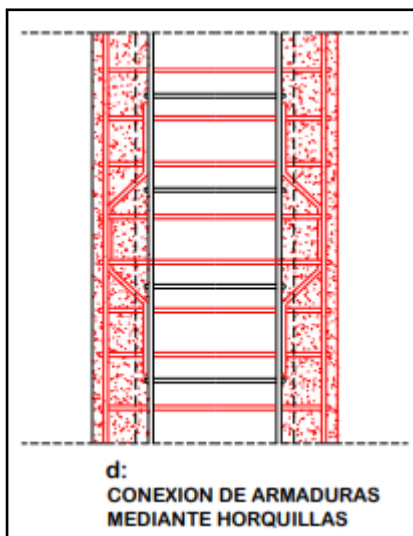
Acero de refuerzo armado mediante horquilla.
